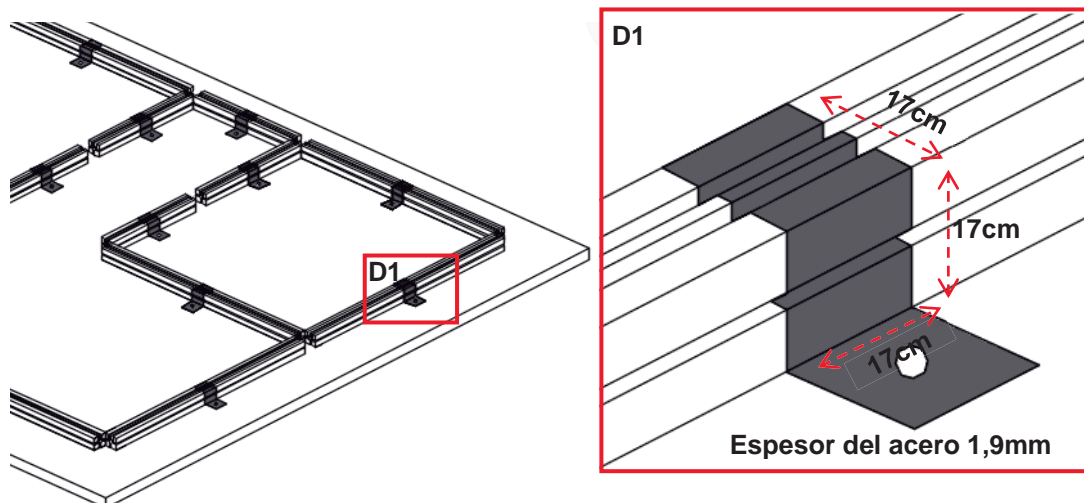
Anclaje de vigas con la placa de hormigón - AutoCAD, 2018
